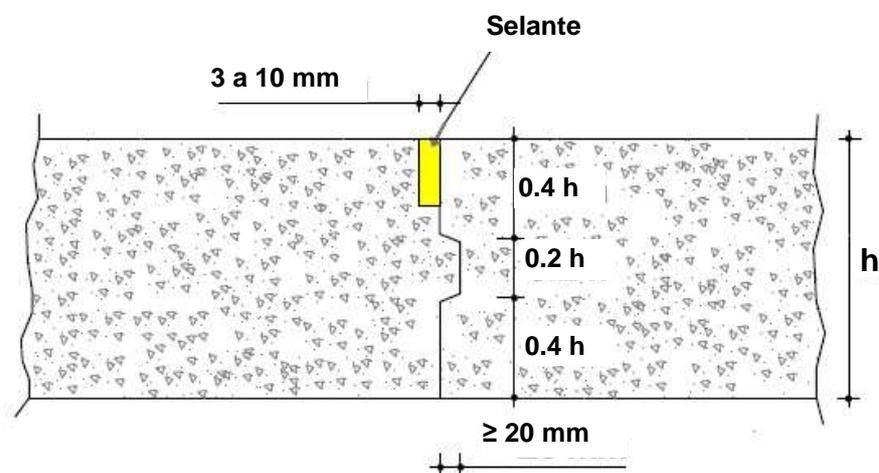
Junta longitudinal do tipo macho-fêmea.
